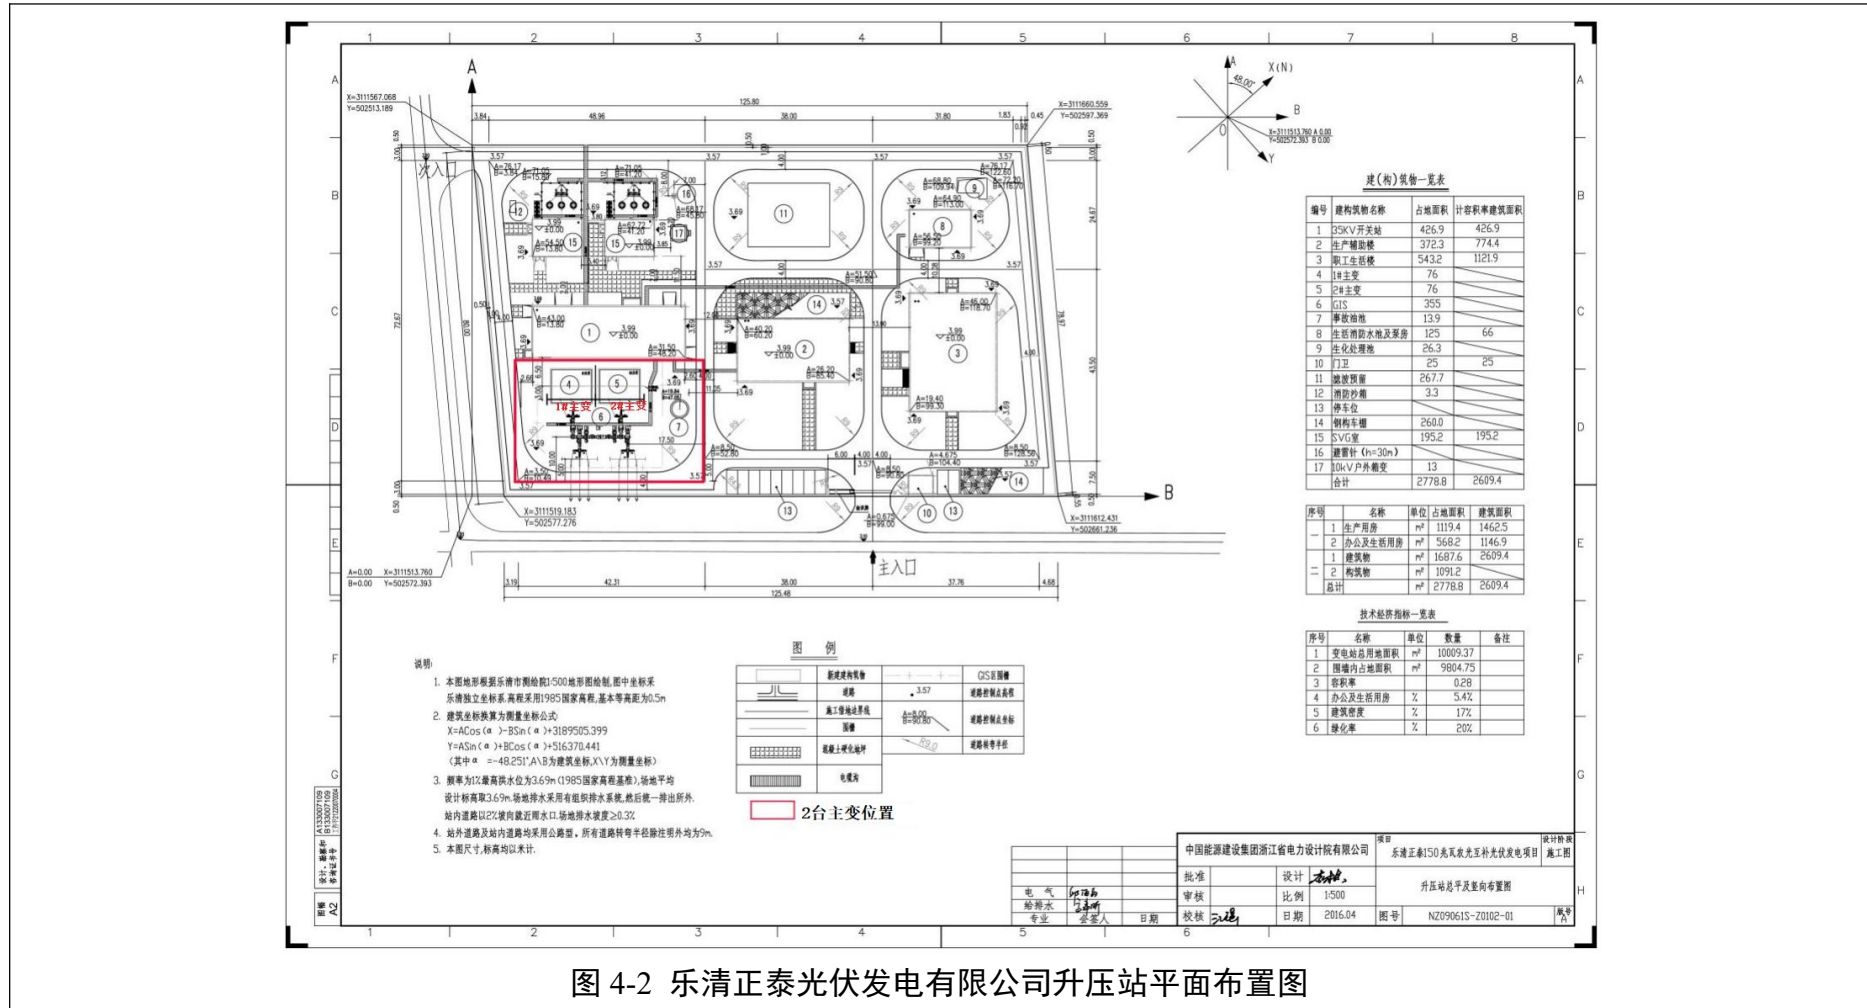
乐清正泰光伏发电有限公司升压站平面布置图
